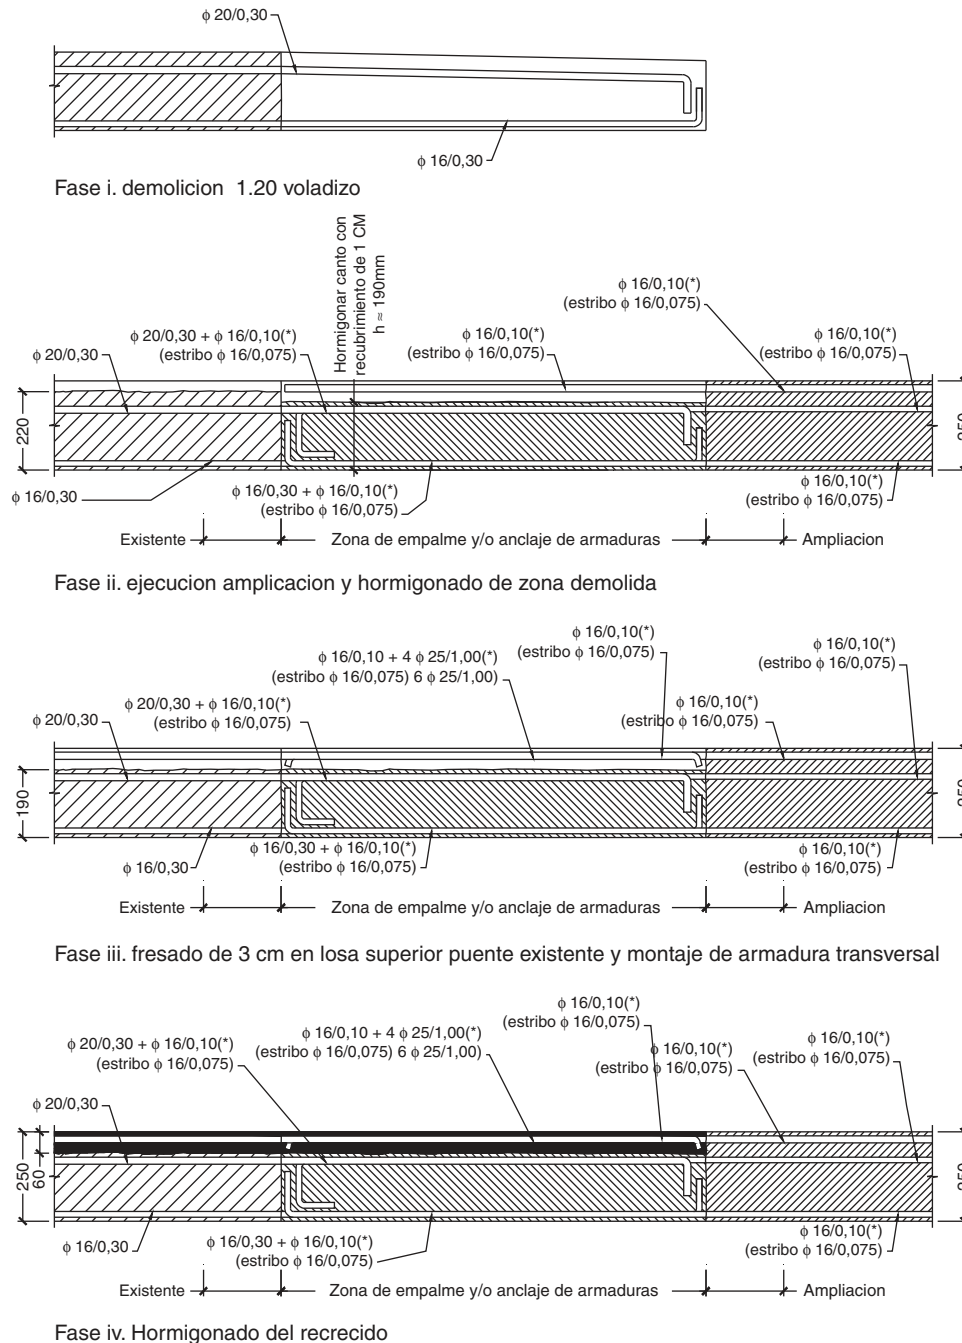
Fases constructivas y disposición de armadura para la conexión entre la losa existente y la nueva losa.
